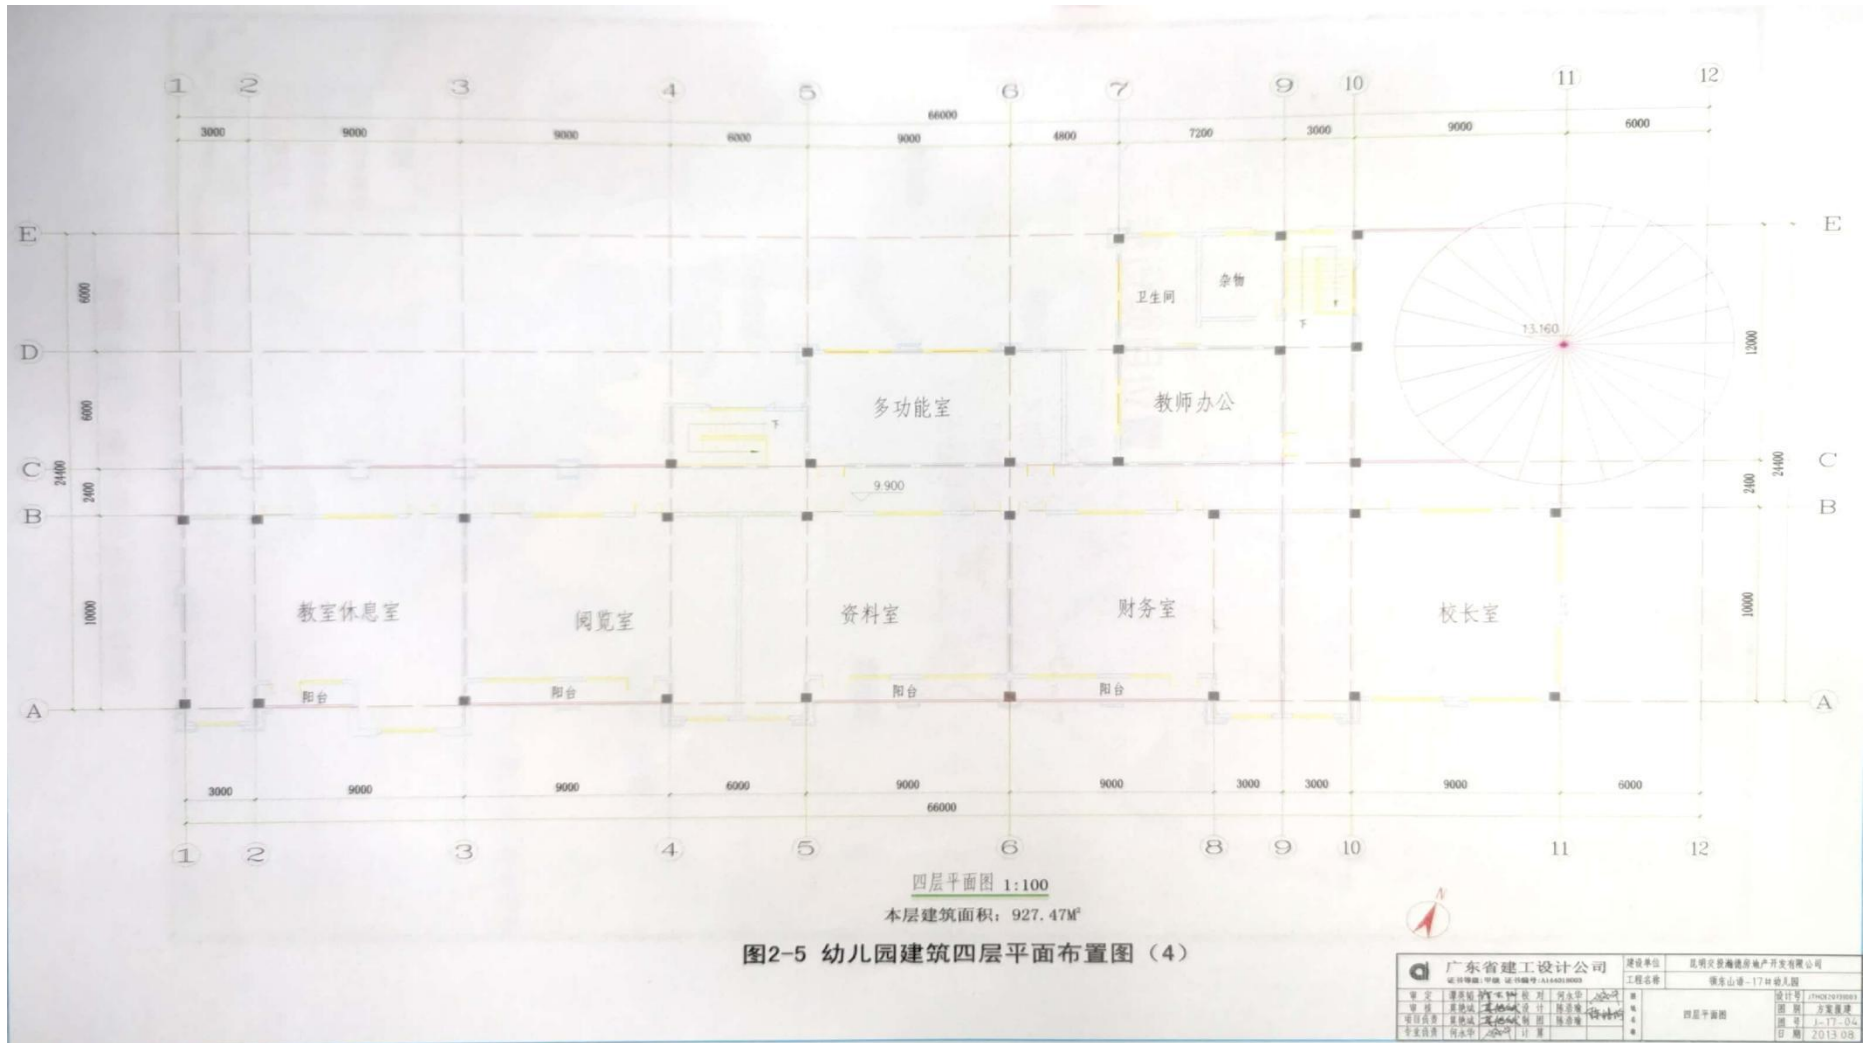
项目 A2 地块幼儿园地上四层平面布置图
